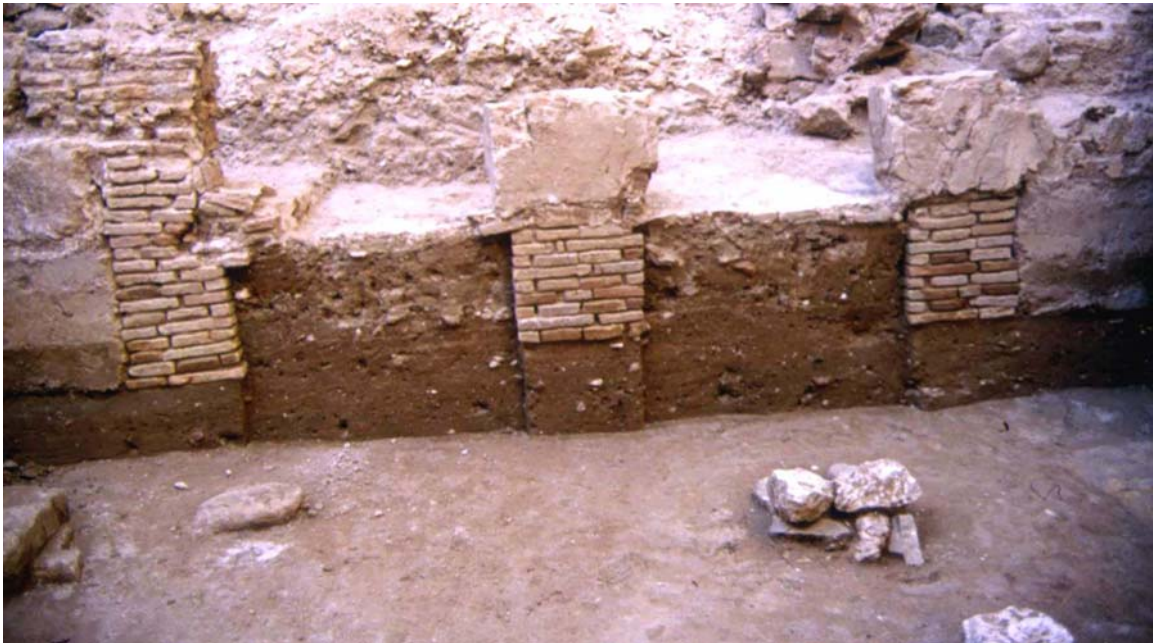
Murcia. Casa excavada en el casón de Puxmarina de Murcia (s. XII). Muros construidos con cimentación de tapial de hormigón y jambas y pilar central de un vano geminado fabricados con ladrillo (Jiménez Castillo, Navarro Palazón y Thirirot, 2005)
